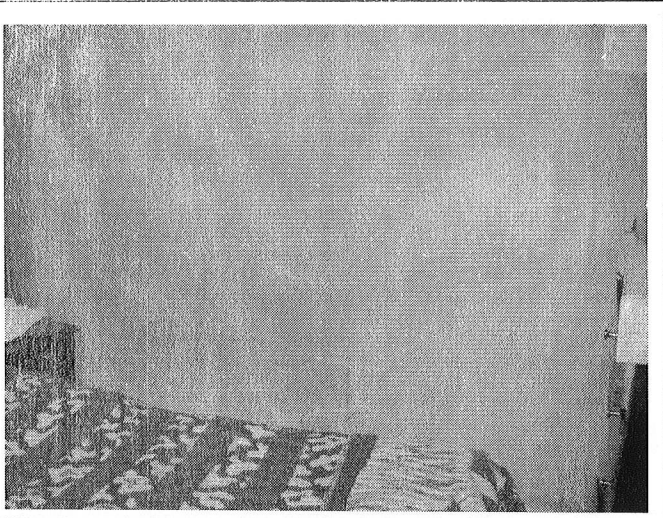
Predio Manzana 10 Lote 2, Diagonal 70 A Sur No. 1 D – 74 Este, Barrio Yopal Pedregal
